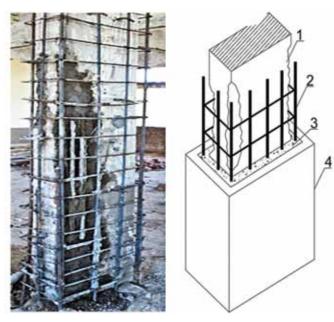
Порядок восстановления железобетонной конструкции: 1 – усиливаемая конструкция; 2 – дополнительный дублирующий армокаркас; 3 – ремонтная бетонная смесь; 4 – шитовая опалубка
